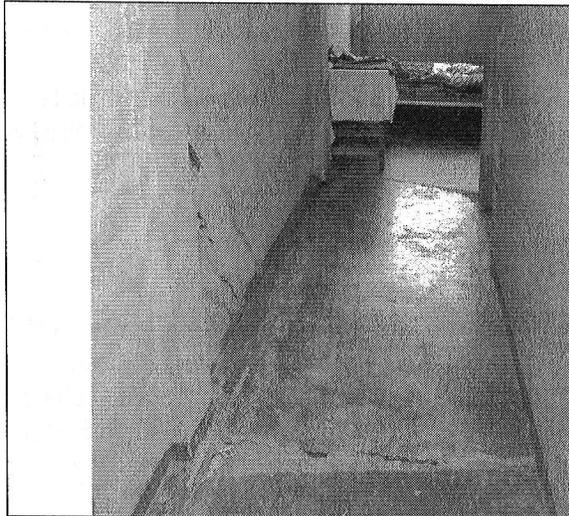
Grieta de tracción que se desprende en dirección sur del escarpe secundario del proceso, localizado en la parte baja de la ladera (tomada 02-04-2009).
